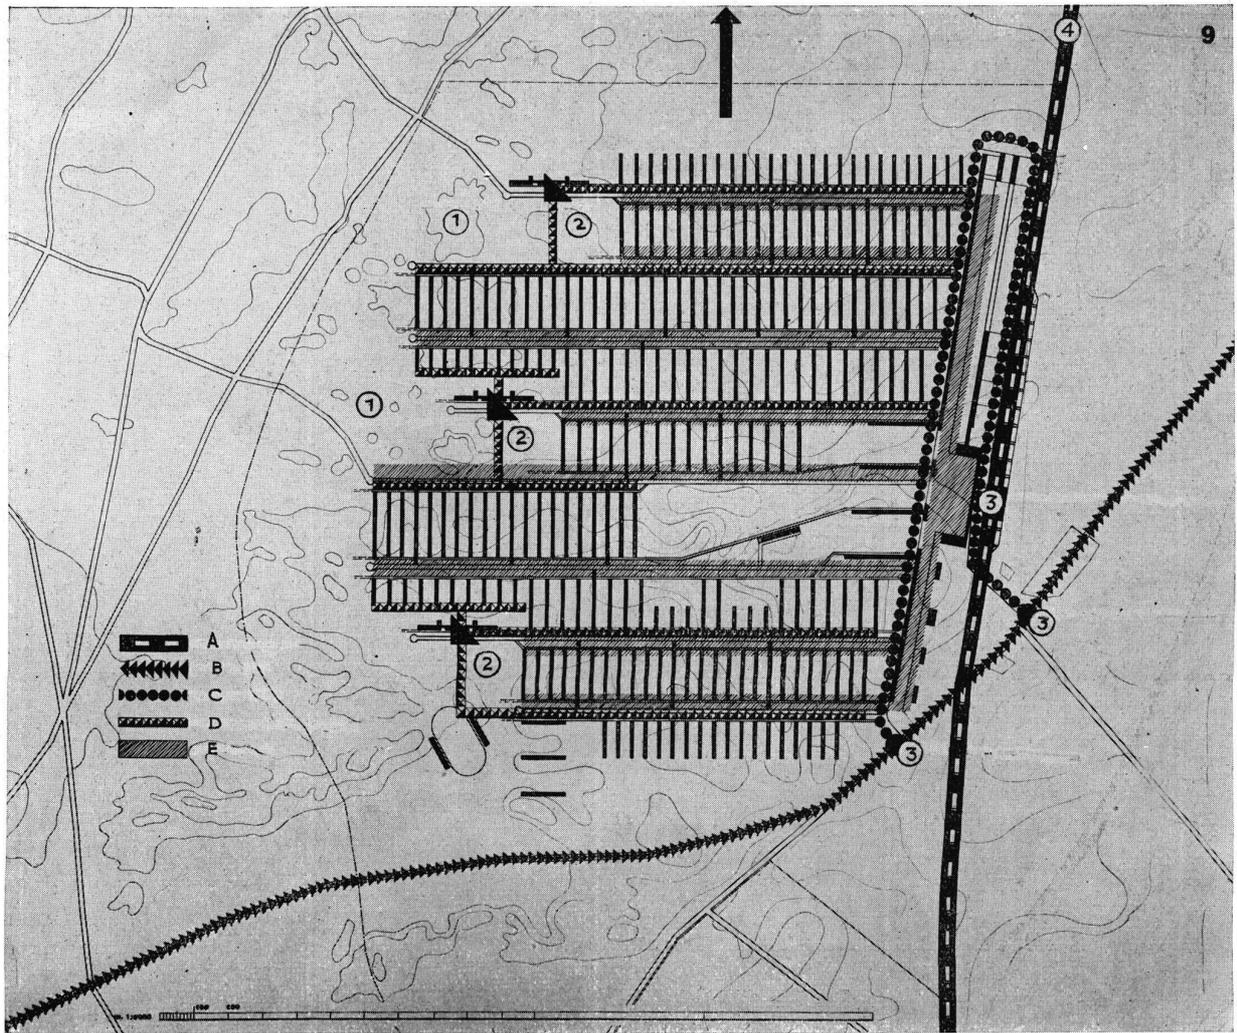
PLANO DE TRAFICO. TERRENO II
